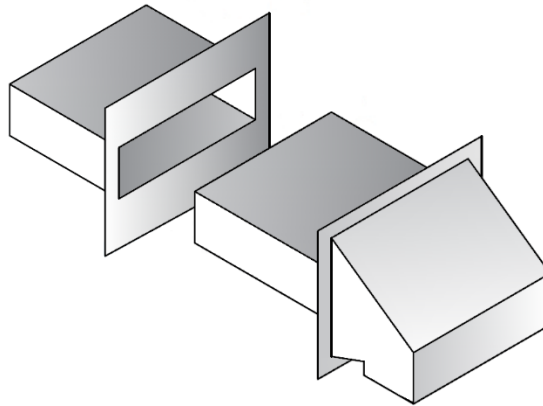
Croquis schématique d'un dispositif de prise d'air ou d'évacuation d'air (manchon et capotin) conforme aux exigences de la SHQ
